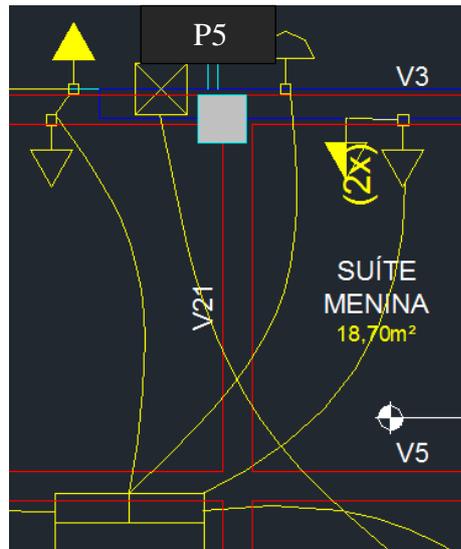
Incompatibilidades entre pilar P5, caixa de passagem e eletroduto.
